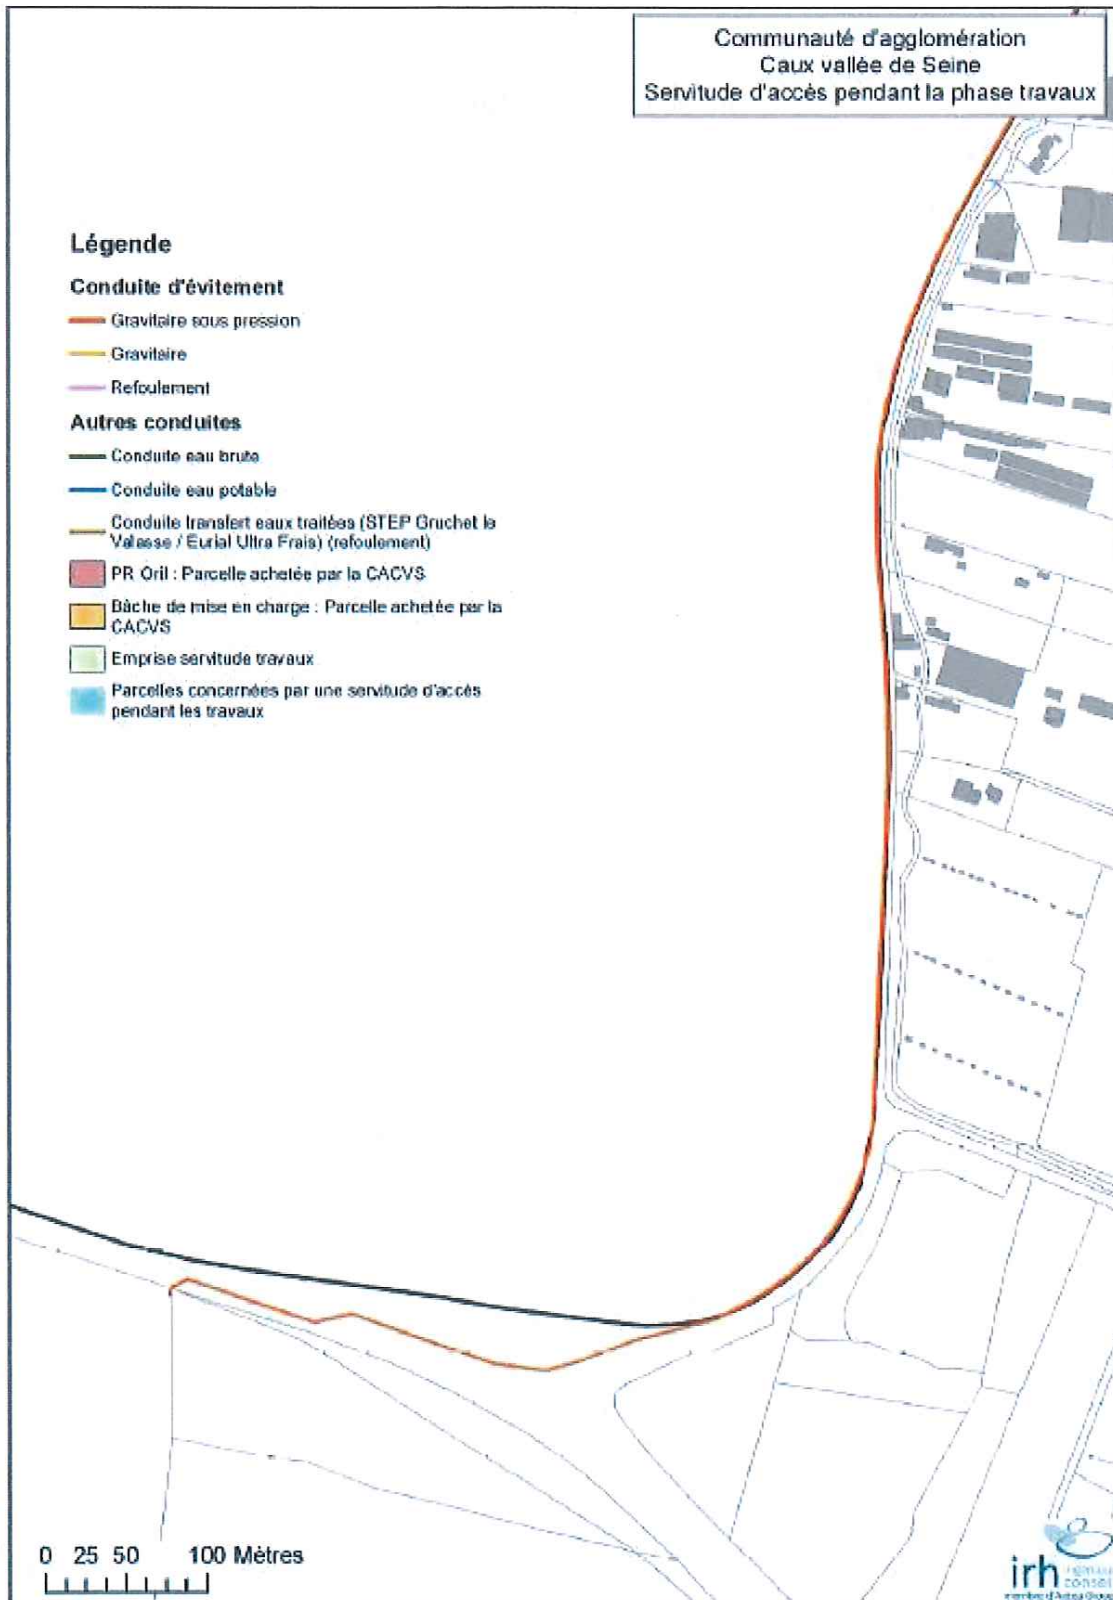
Servitudes pour pouvoir accéder au chantier de pose de la conduite d'évitemment et les conduites d'eau brute et d'eau potable (16/16)
